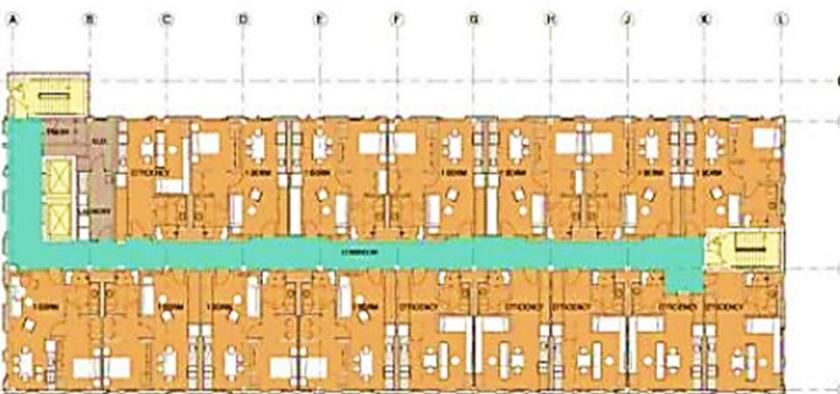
Planta Pavimento Tipo | Autor: Gensler
